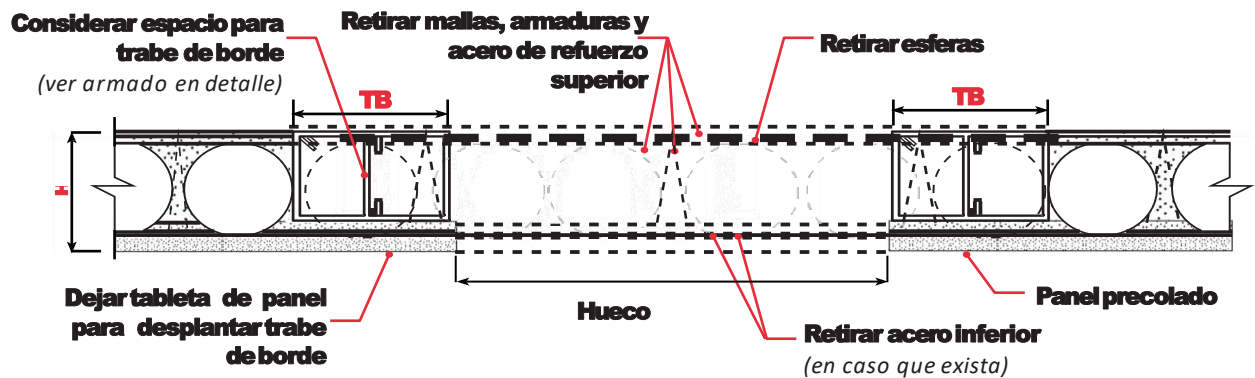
Detalle de corte de losa y colocación de trabe de borde para cortes con máximas dimensiones
